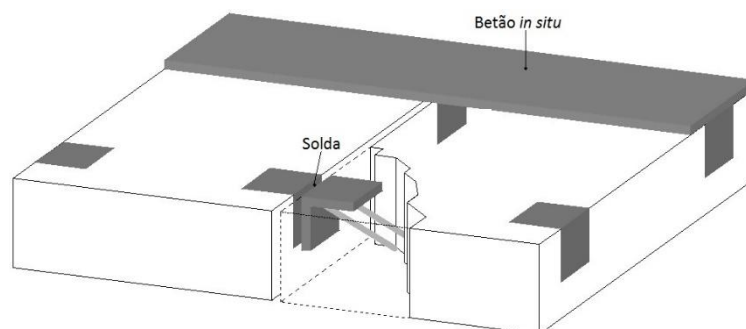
Ligação entre pré-lajes maciças através de chapas soldadas
